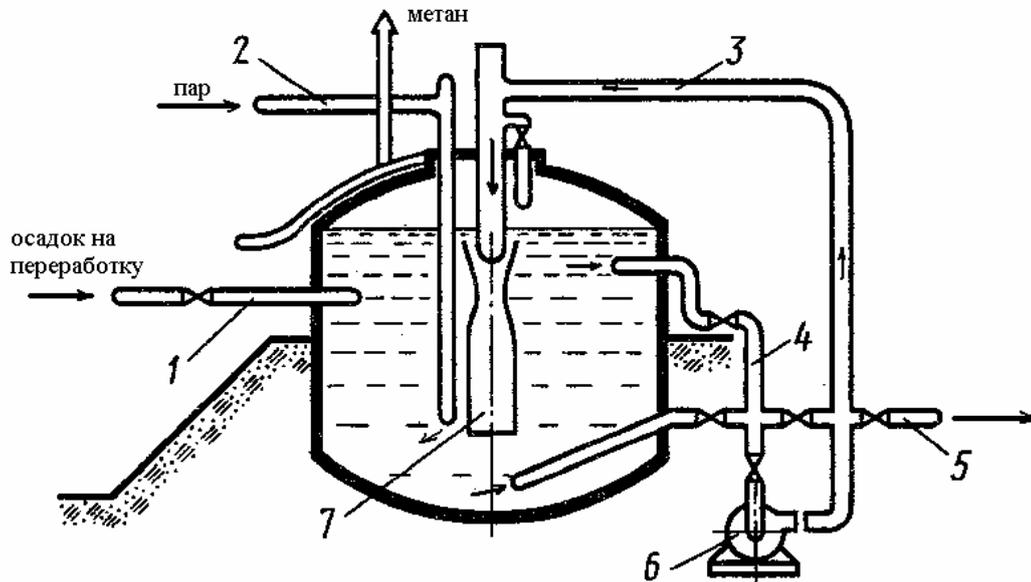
Схема устройства метантенка. 1 – приемная труба; 2 – подача пара; 3 – трубопровод циркулирующего осадка; 4 – выпуск иловой воды; 5 – выпуск сброженного осадка; 6 – насос для циркуляции и перемешивания осадка; 7 – гидрозелеватор.
